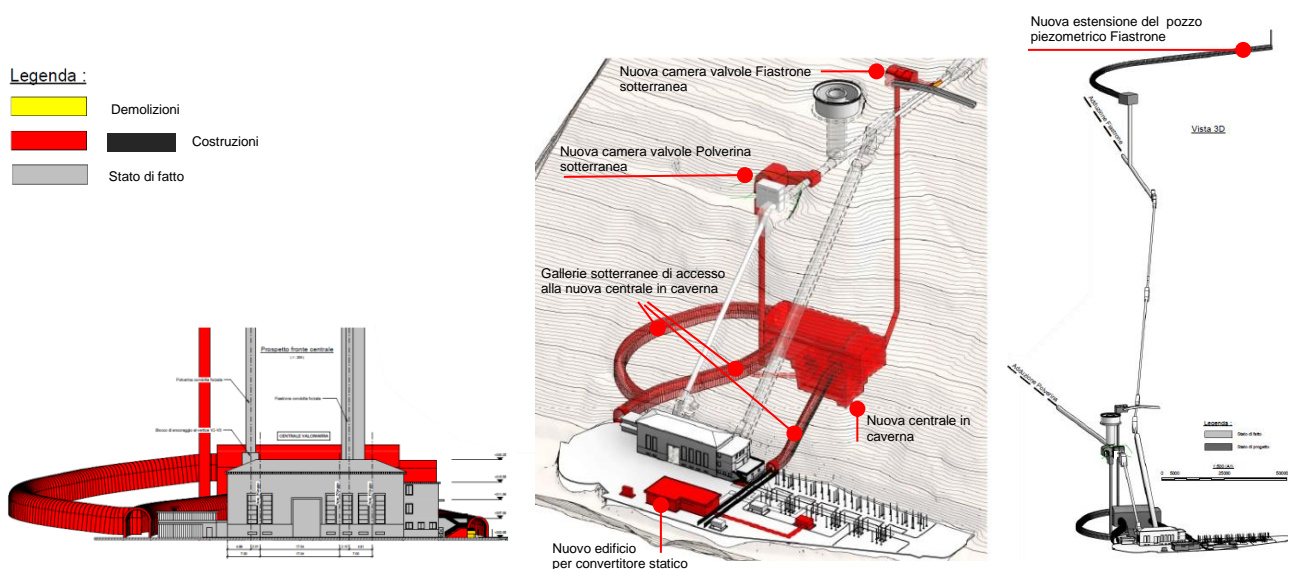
Prospetto versante e Centrale – stato di fatto (in grigio) e stato di progetto (in rosso)
